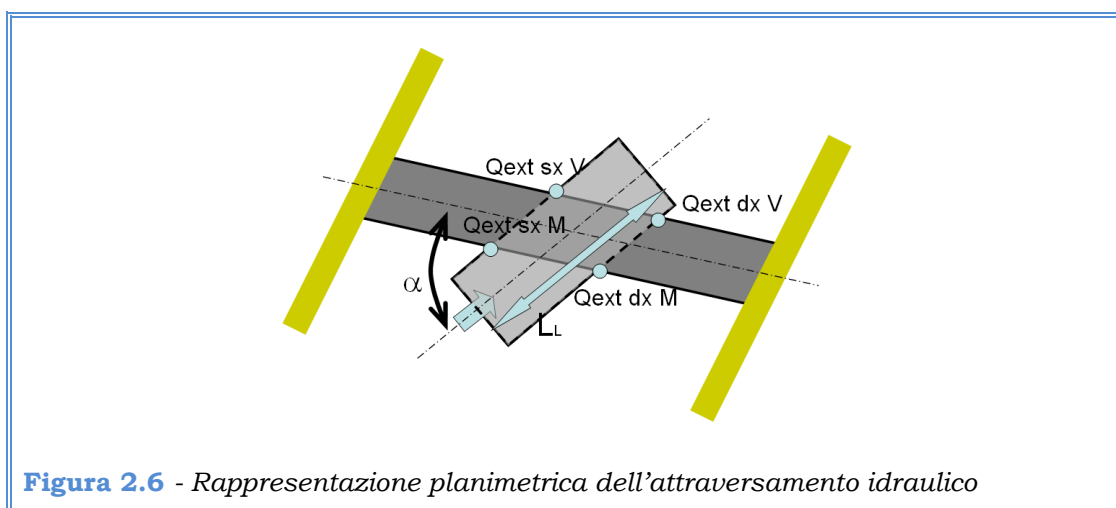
Rappresentazione planimetrica dell'attraversamento idraulico
